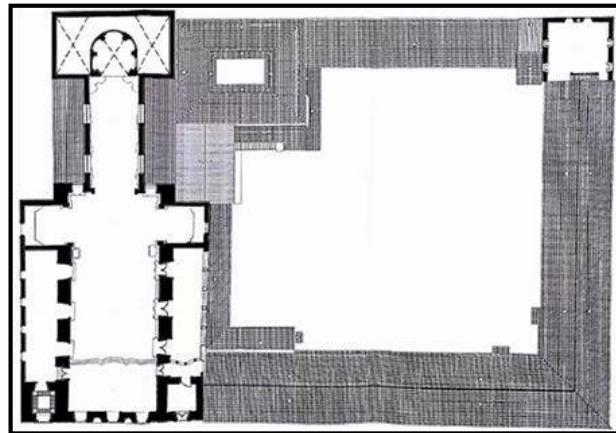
Planta Baixa do terceiro pavimento da Basílica Nossa Senhora do Carmo. Fonte: INBMI - IPHAN. 2015.
